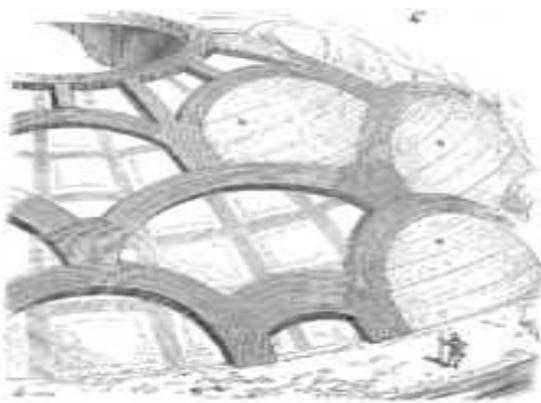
Coupe du mur de la rotonde :1) extérieur. 2) intérieur. 3) exèdre et colonne alternant avec les piliers pleins .4) base de la coupole. 5) surélévation du mur. 6) anneaux de charge.source : Encarta 2005.
